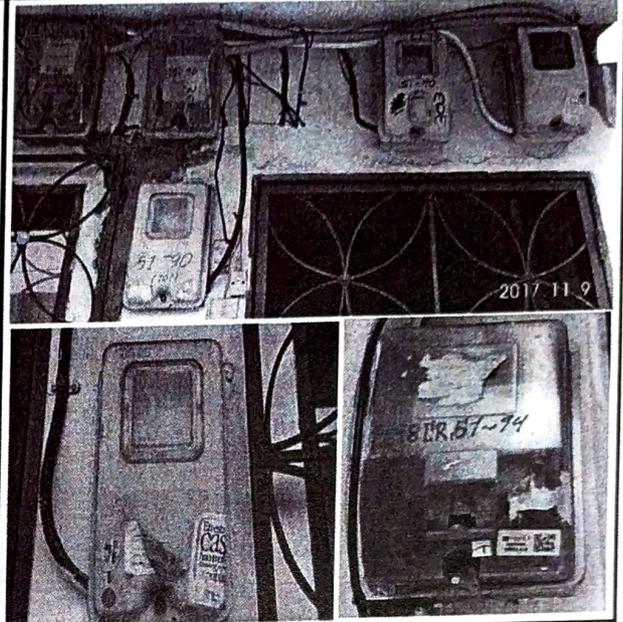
CONTADORES VIVIENDAS - LOCAL
